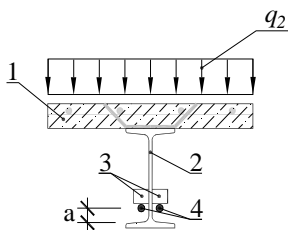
Расположение напрягаемой арматуры в сечении сталежелезобетонной балки в середине длины пролета:
